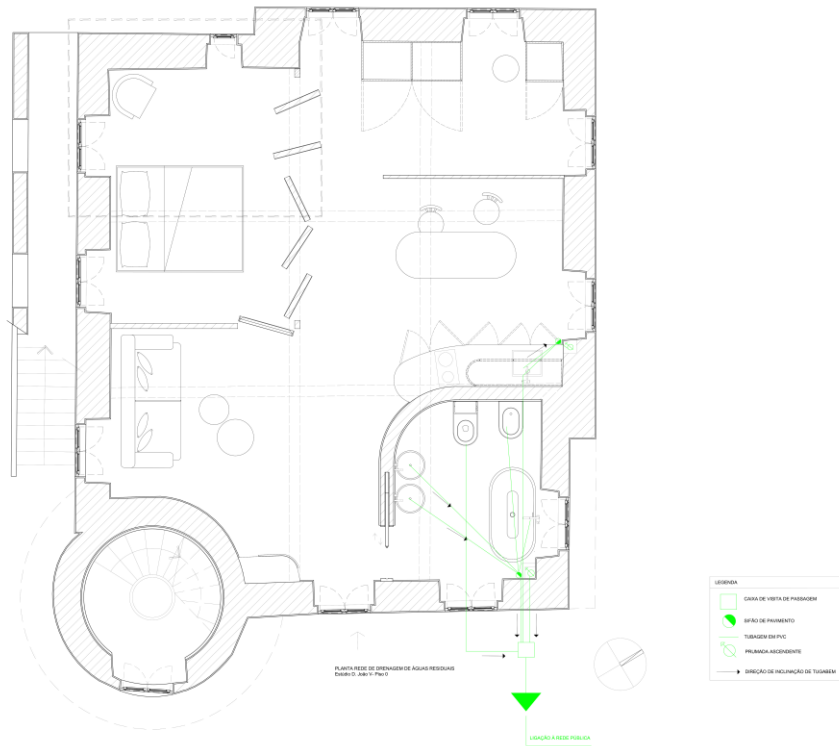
Planta Rede de Drenagem de Águas Residuais- Estúdio D. João V;
